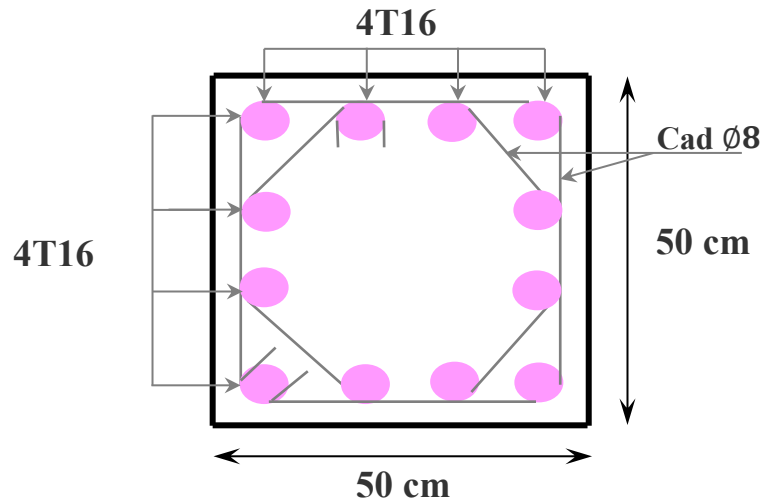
Schéma de ferraillage des poteaux 50x50.
